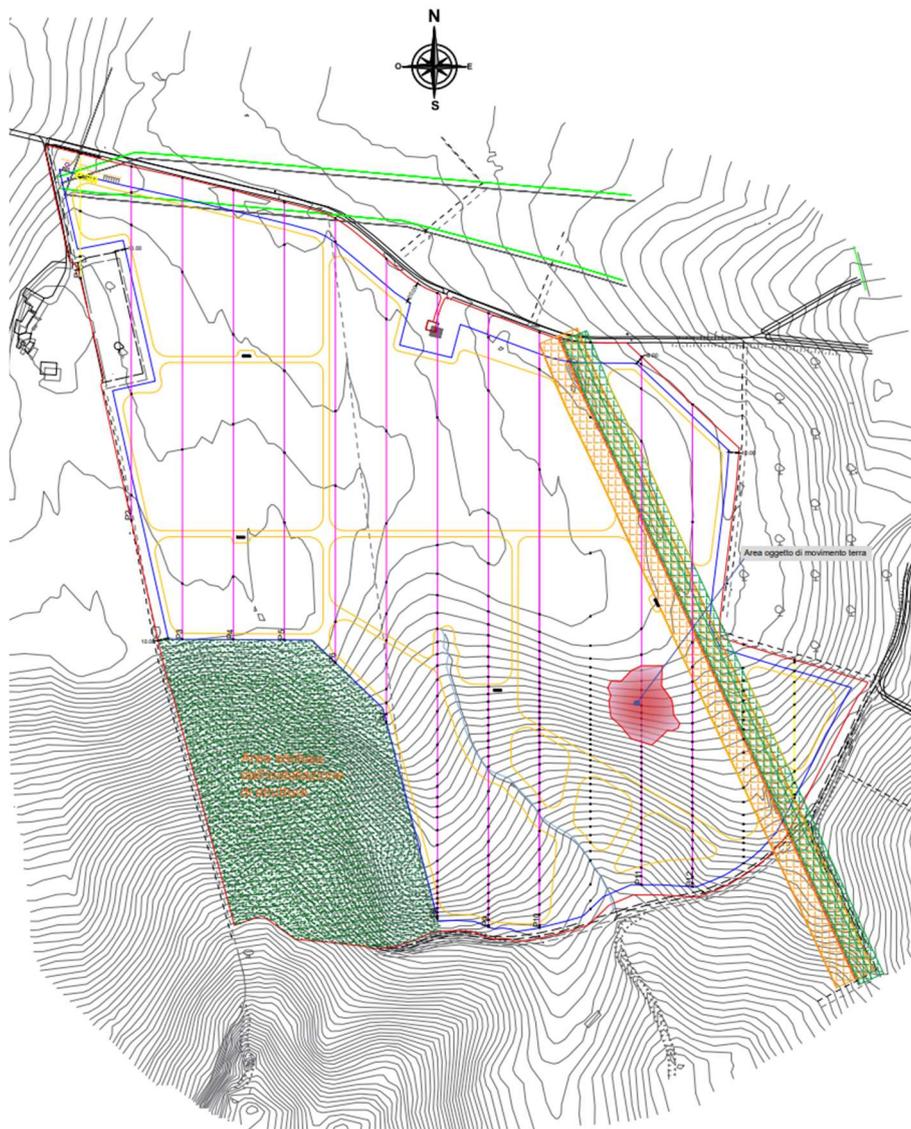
Stralcio elaborato TDA-14\_c\_Verifica preliminare Movimento Suolo.pdf
